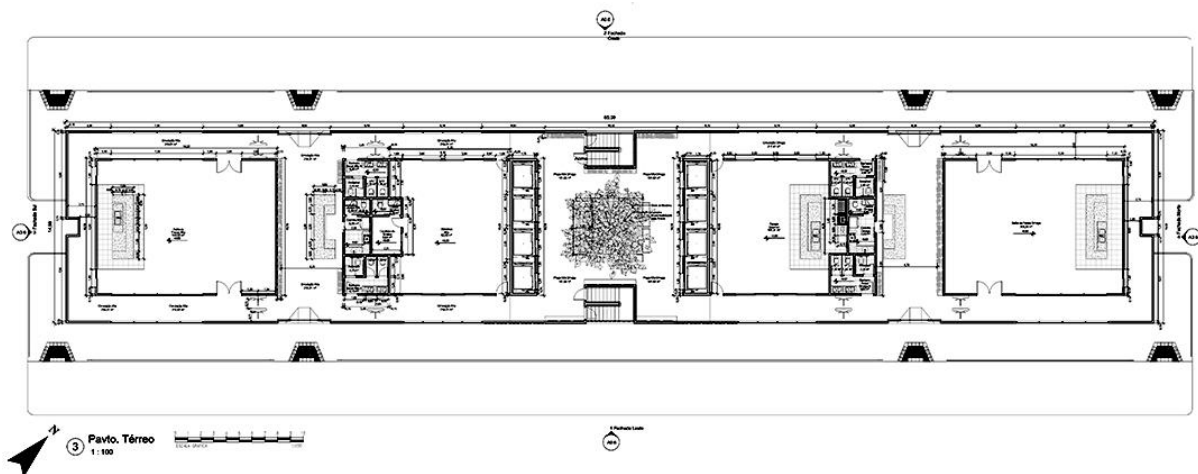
Planta Baixa Pavimento Térreo – Projeto Sanctum.
